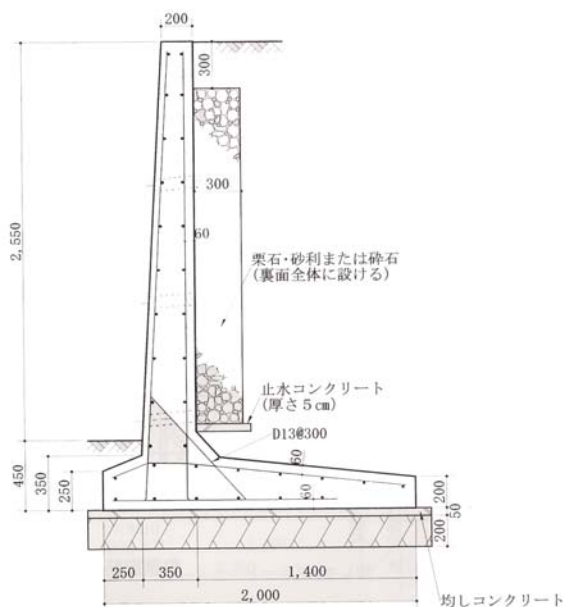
標準構造図（鉄筋コンクリート倒立 T 型擁壁、高さ 3m の場合）
